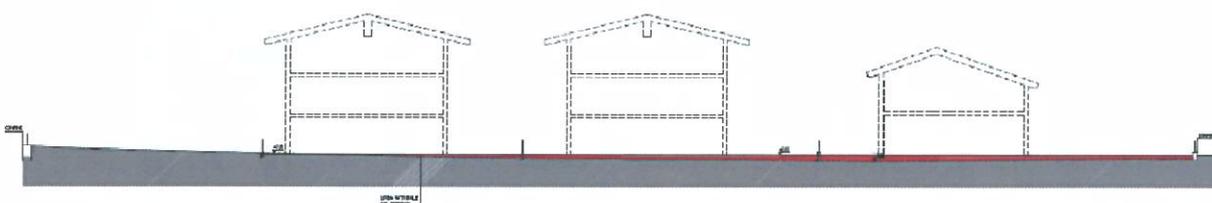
Estratto "Sezione longitudinale B-B di progetto" scala a vista.
